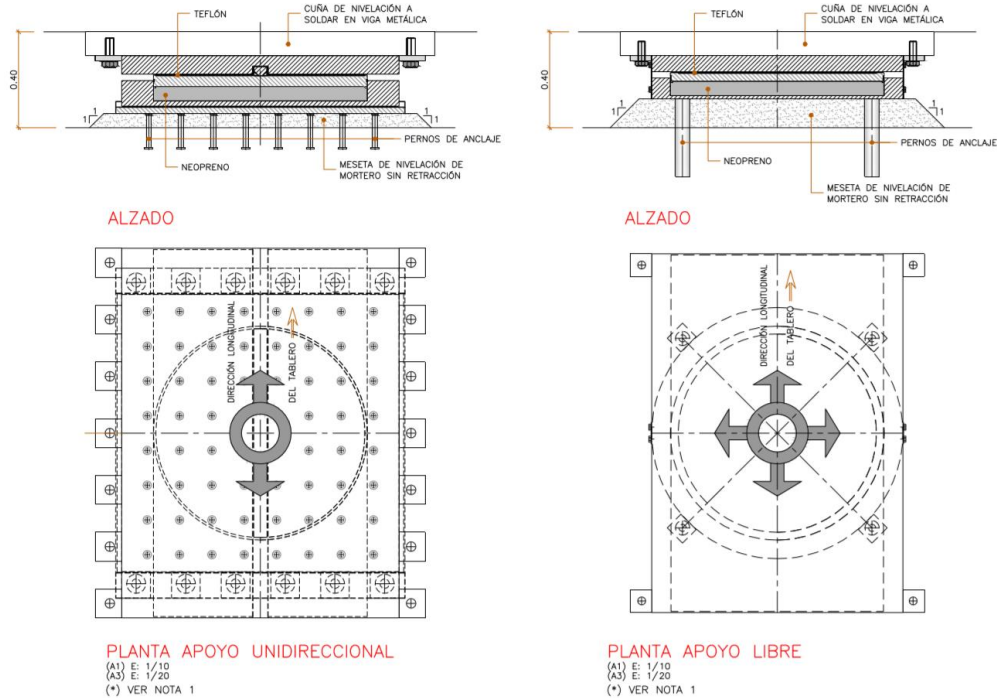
Apoyo libre y unidireccional colocados sobre las pilas. Fuente: Proyecto de construcción de plataforma del corredor mediterráneo de Alta Velocidad Murcia – Almería.
